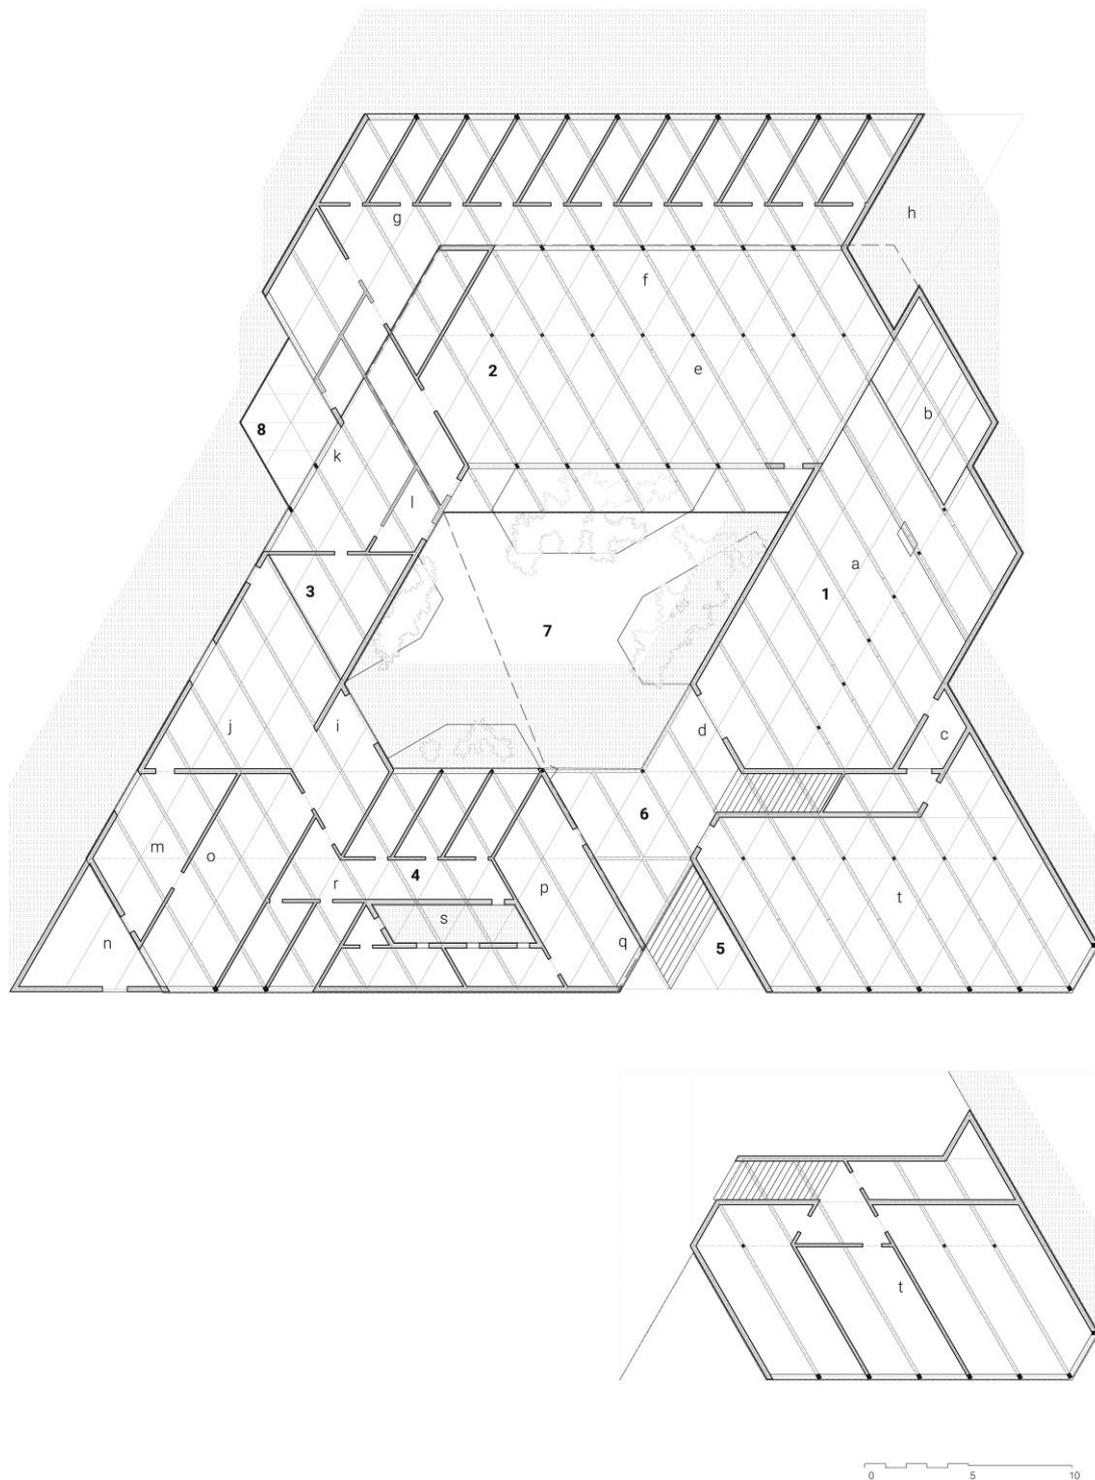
Plantas baja y sótano de la Capilla Santa María del Pozo. Abril 2020.
